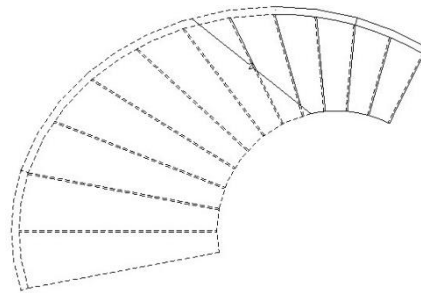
Primer tramo de la escalera (Vista de planta Nivel Plaza)
